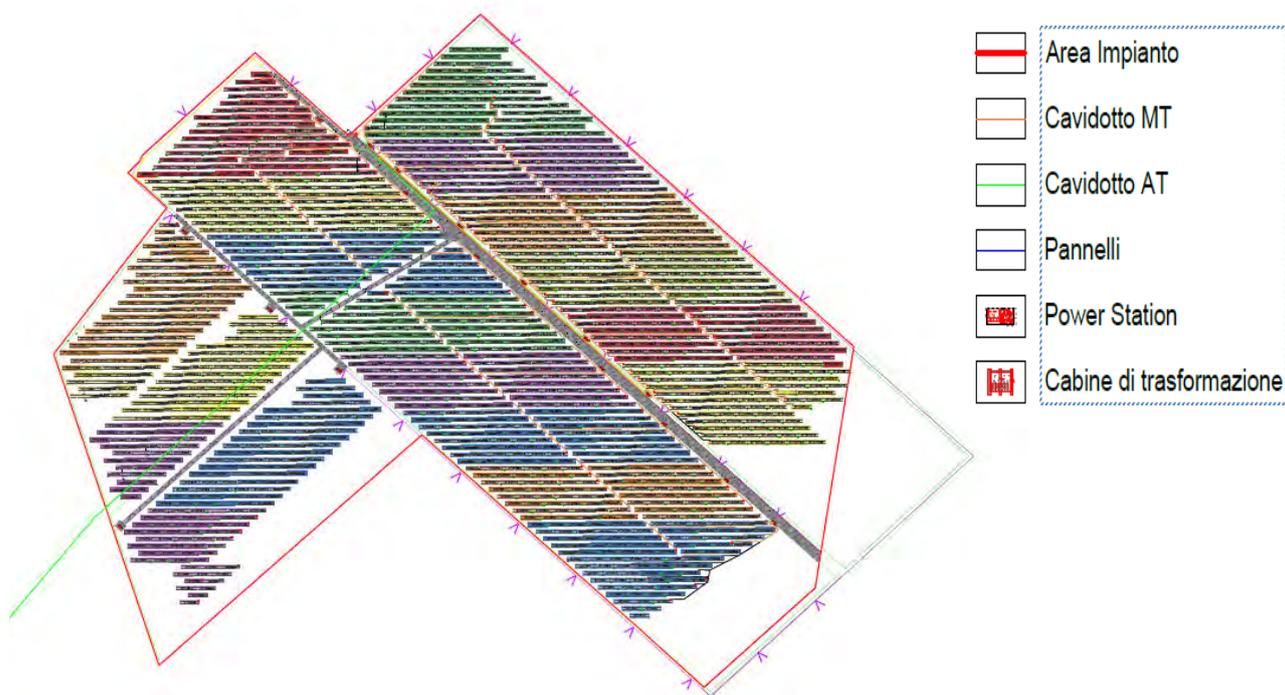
Layout impianto fotovoltaico definitivo (Vedi XK1J275_47.Planimetria generale dell'impianto_Rev1)
